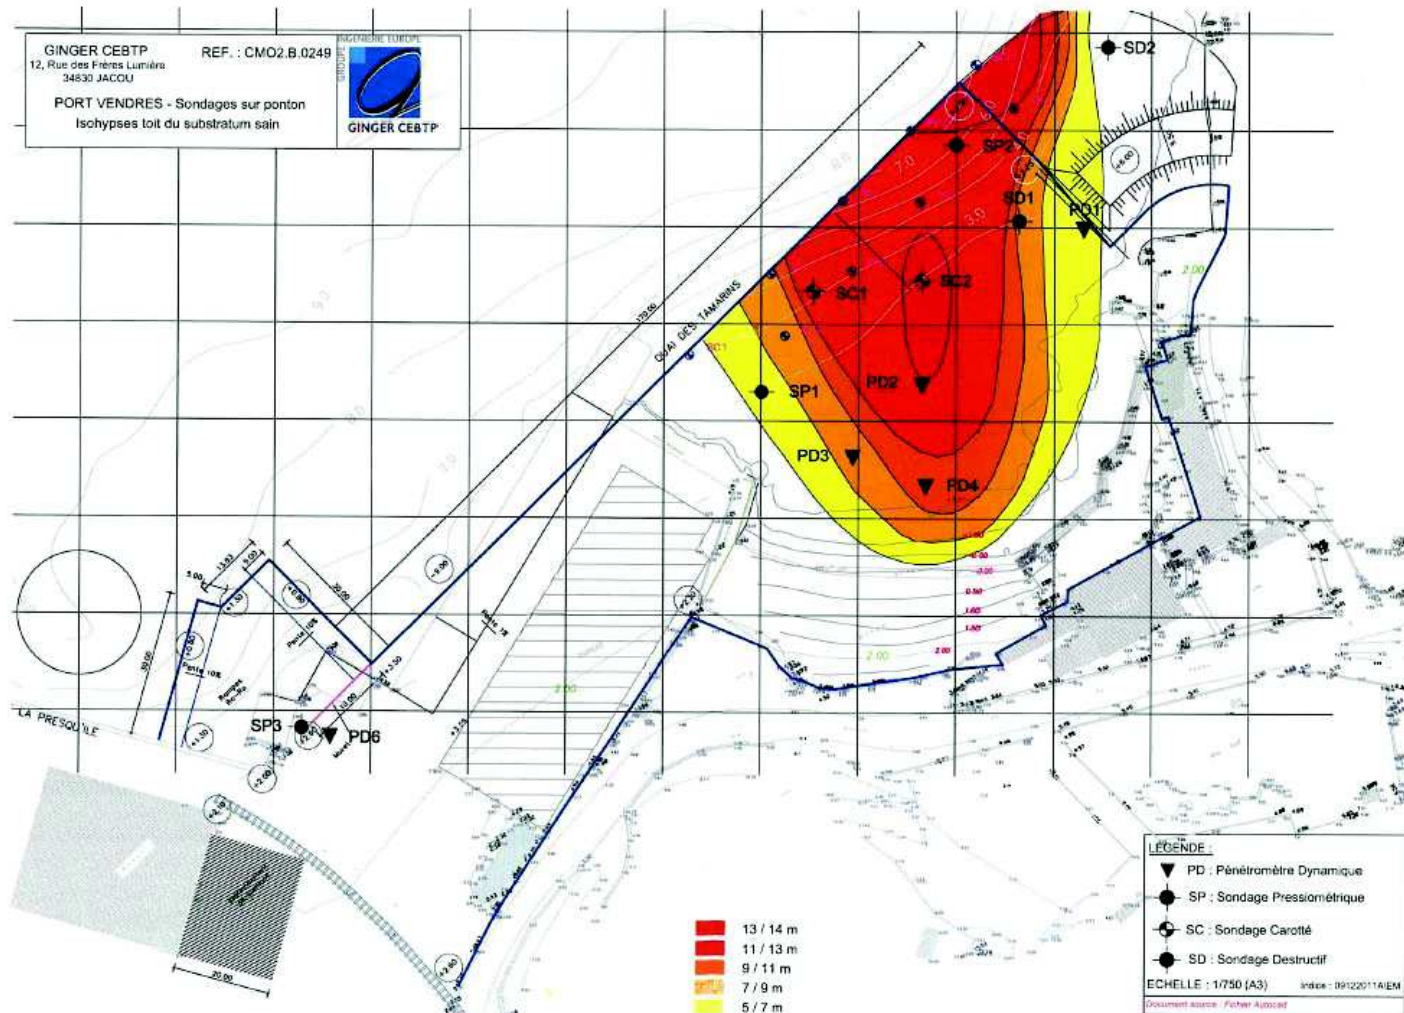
Plan des isohypses du toit du substratum sain (GINGER CEBTP, 2011)
